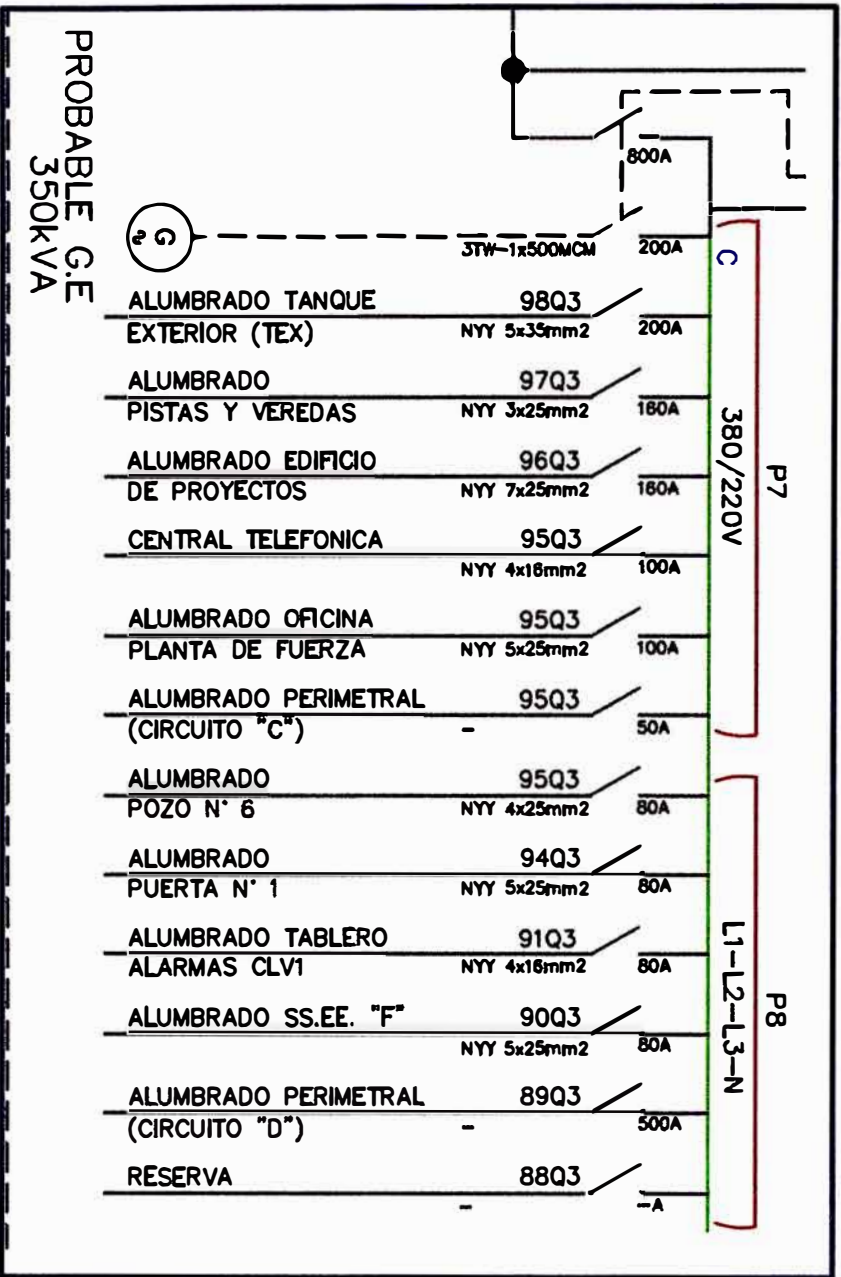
Subestación eléctrica F2 (Planta de Fuerza2) – Tablero 3
